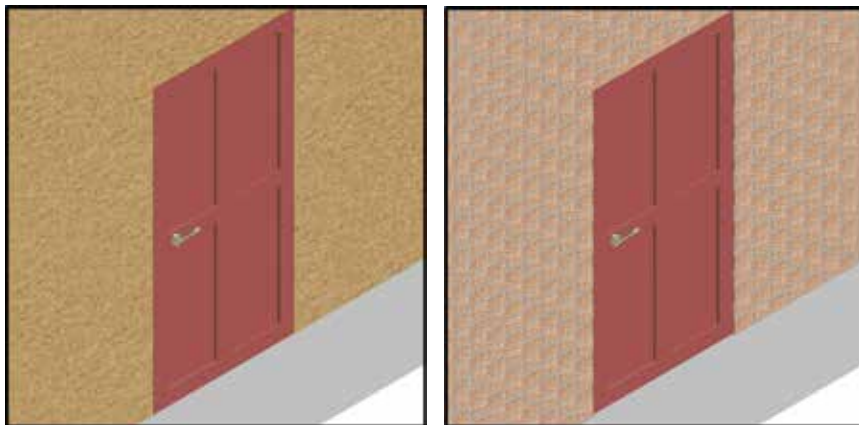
Монтаж фасадной плитки вокруг дверного проёма.
